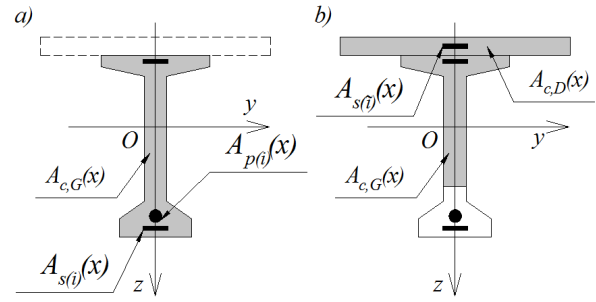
a) Sección de la viga. Capas de acero pasivo y activo no adherente. Ejes de referencia. b) Sección de la viga compuesta. Áreas de hormigón no fisuradas.
